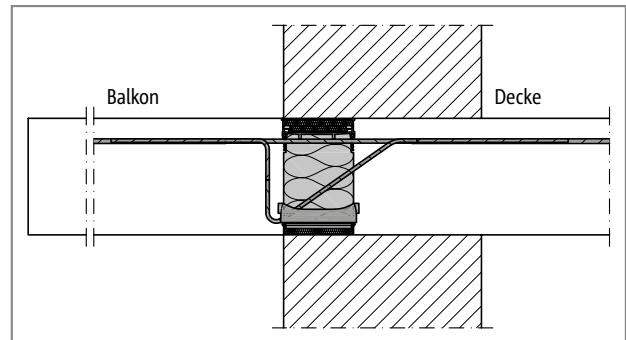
Schöck Isokorb® XT Typ K: Anschluss bei einschaligem Mauerwerk
